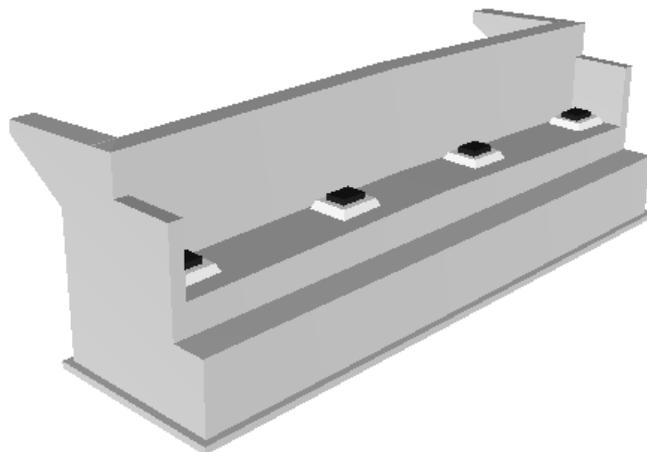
Vista en 3D de la tipología de estribo empleada. Fuente: El. prop.
